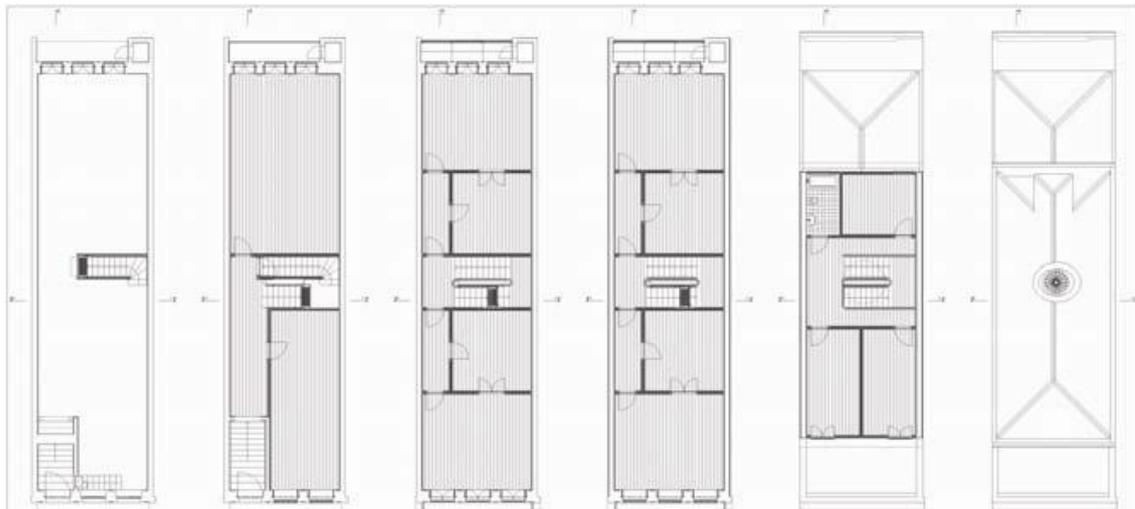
Fig. V - Modelo construtivo da casa burguesa do Porto. Plantas, cortes e alçados (Fonte: POVOAS, Rui, 2011)
